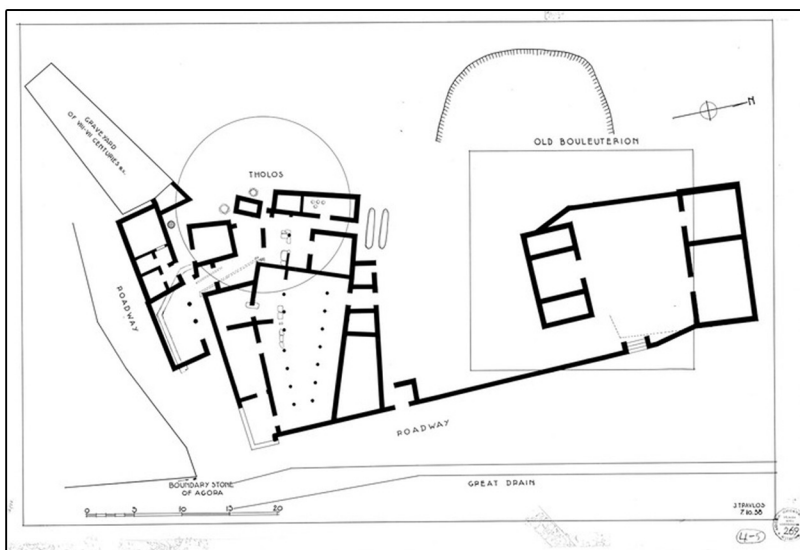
Ricostruzione della planimetria dell'Edificio F
